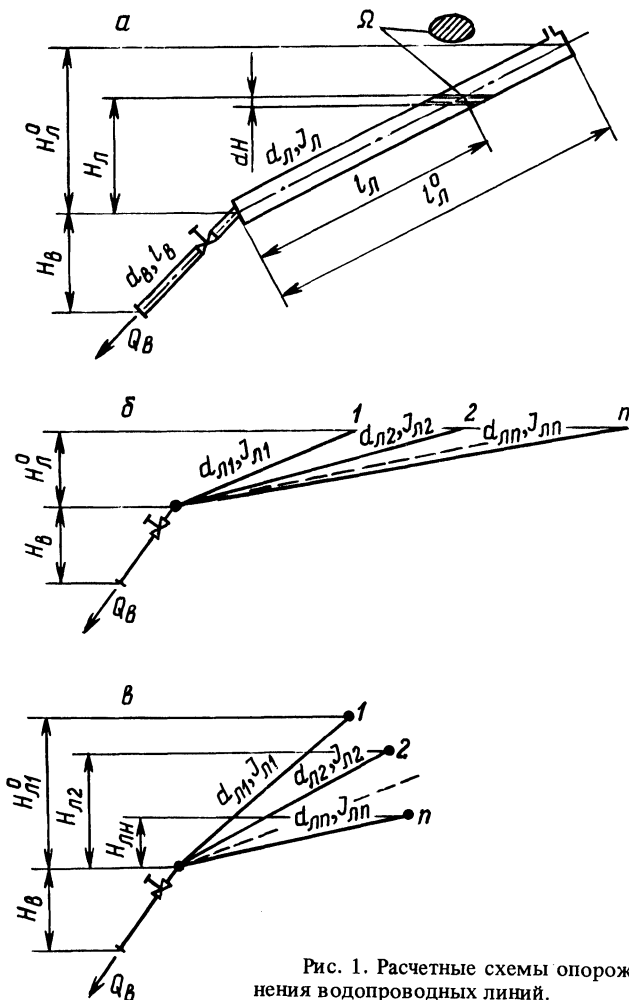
Расчетные схемы опорожнения водопроводных линий.
